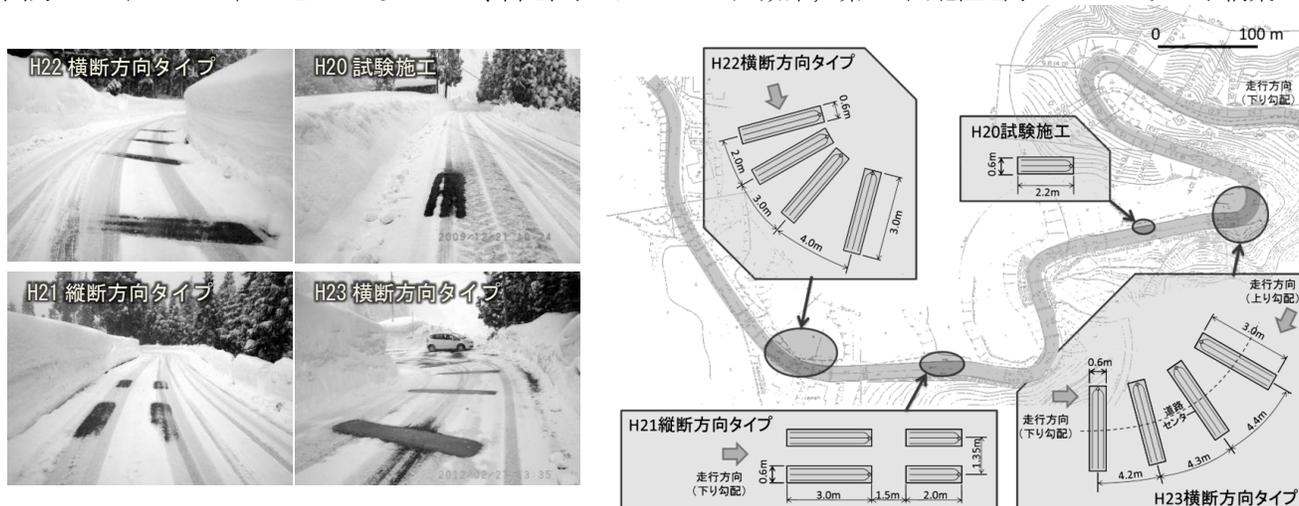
地熱ヒートパイプ融雪施設の施工位置と施工タイプ
